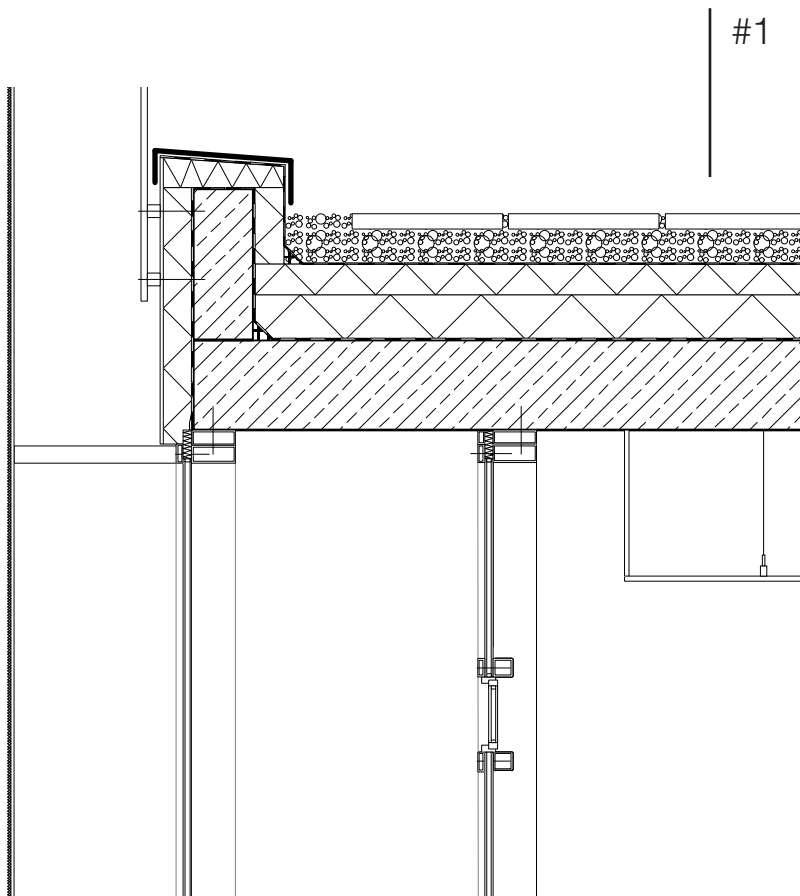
Fassadenschnitt durch den Sportriegel, M 1:125
